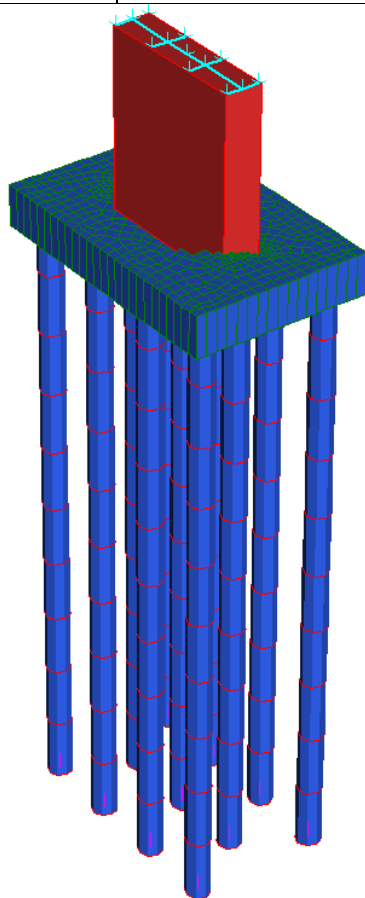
Modellazione tridimensionale agli Elementi Finiti
